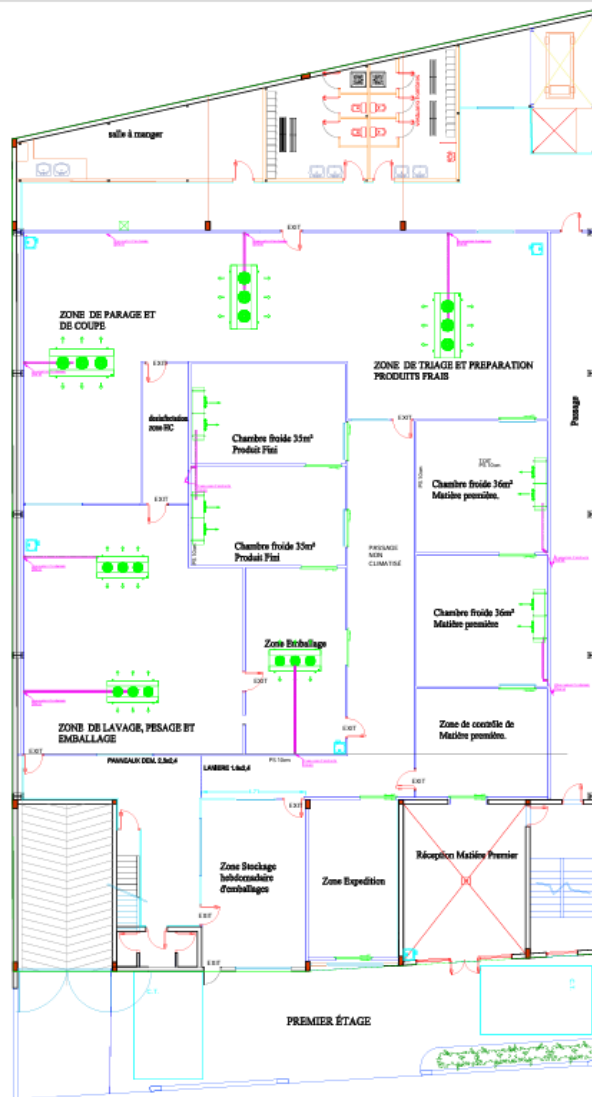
Plan détaillé des zones fonctionnelles du premier étage
